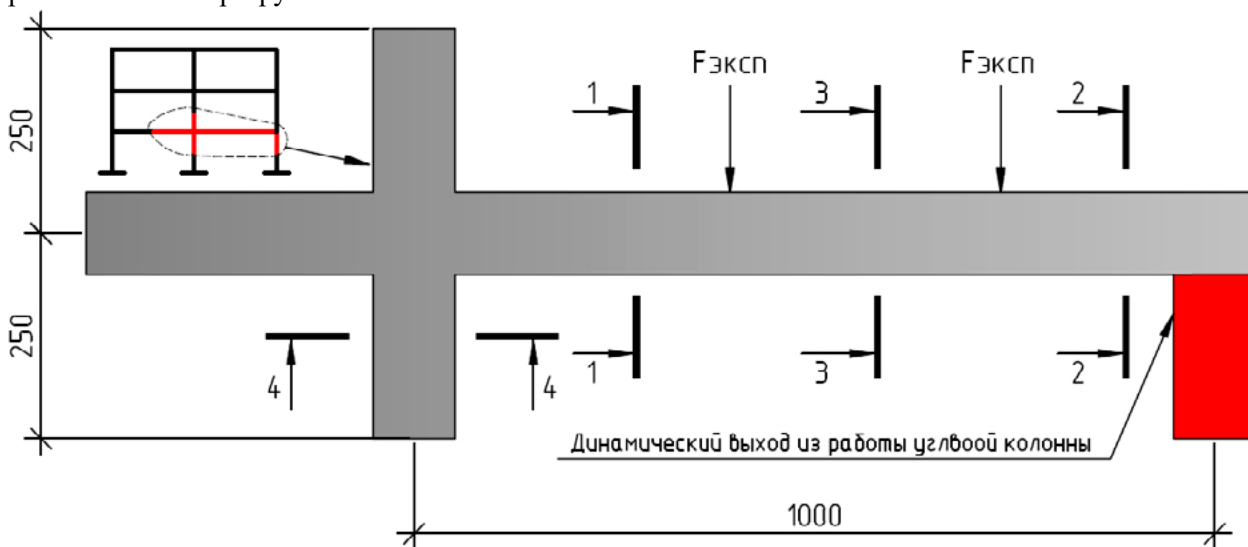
Фрагмент рамного каркаса, моделирующий элемент перекрытия пассажирской платформы.
